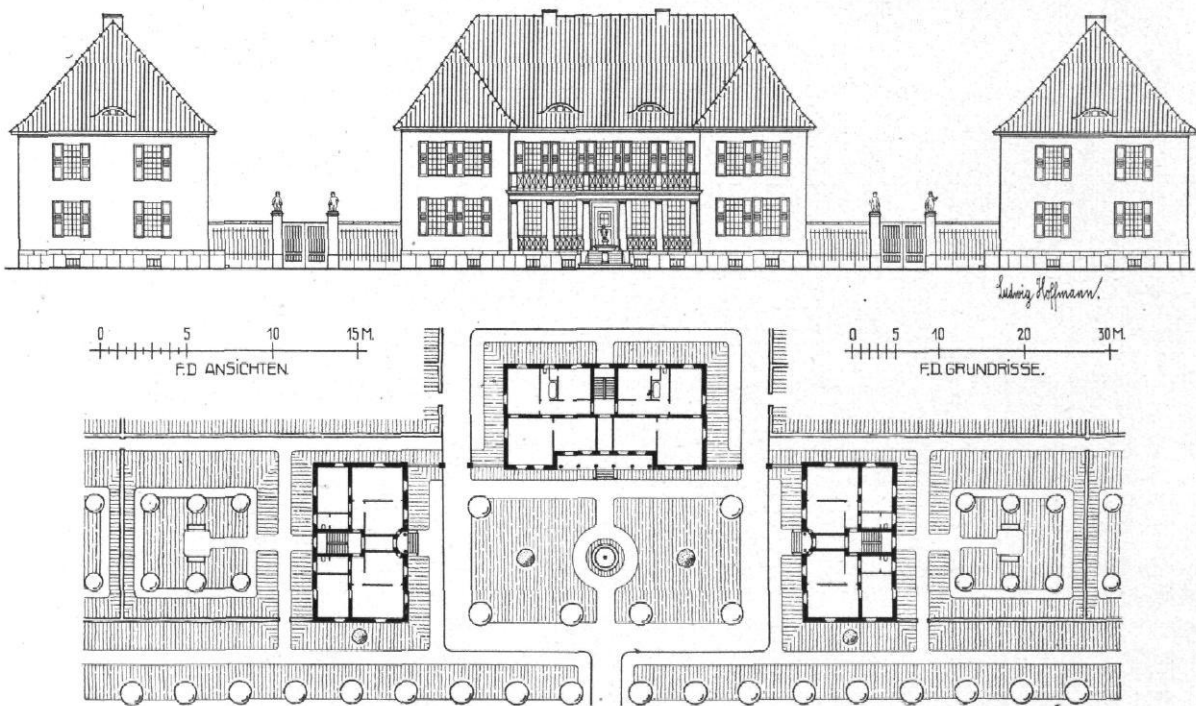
Platz und 3 Wohngebäude. Ansichten und Grundrisse
